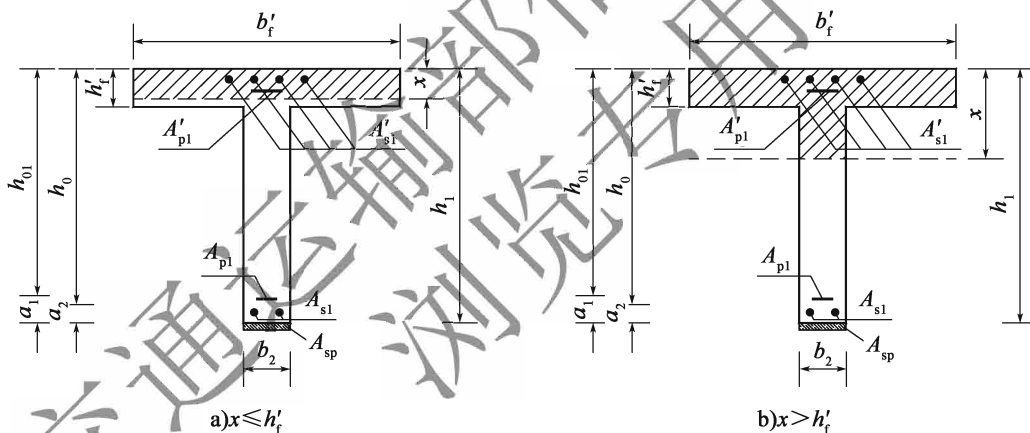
T 形截面混凝土受弯构件增大截面加固正截面抗弯承载力计算
